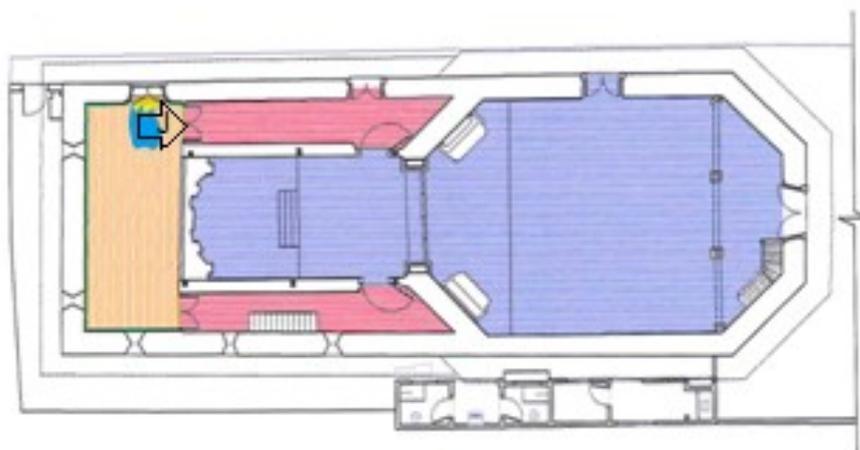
Vista J Sacristia corredor lateral direito - Planta pavimento inferior
